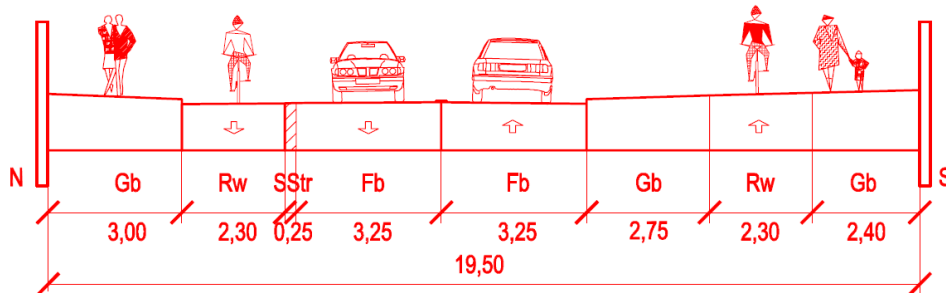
Schematische Darstellung Querschnitt östlich Knotenpunkt Simmernstraße / Rheinstraße - Planung Variante 2 (Quelle: Ing.-Büro Zimmermann)
